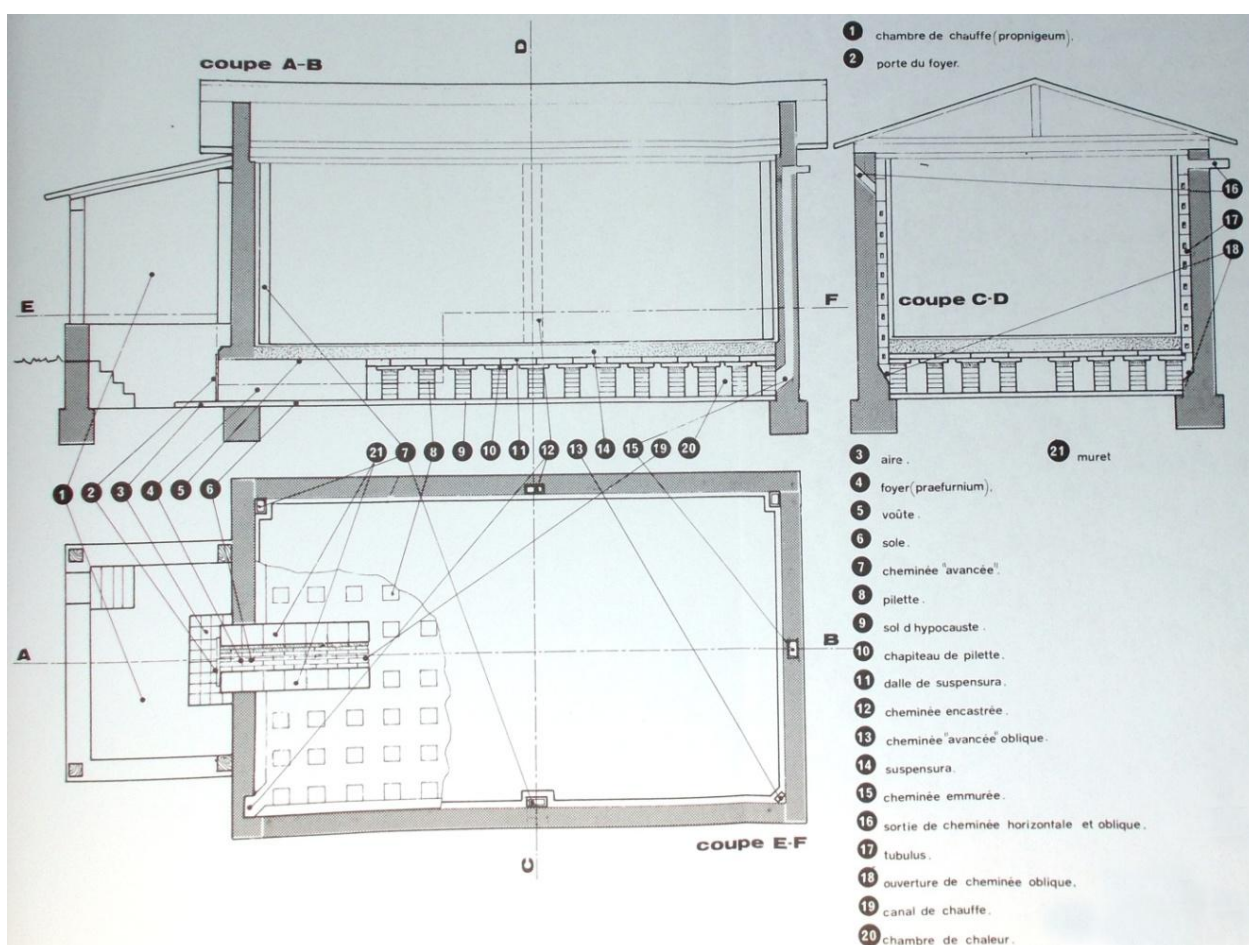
plan général d'un hypocauste. (Degbomont, 1984, d'après F. Kretzschmer)
